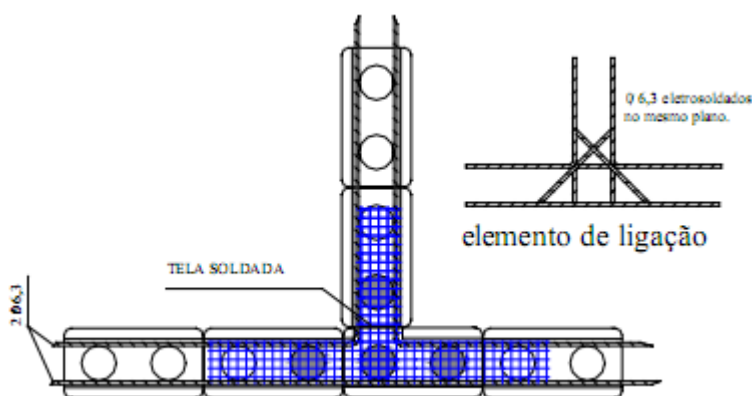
Detalhes sugeridos para as cintas de amarração em encontros de parede. Fonte: SAHARA (2009).
